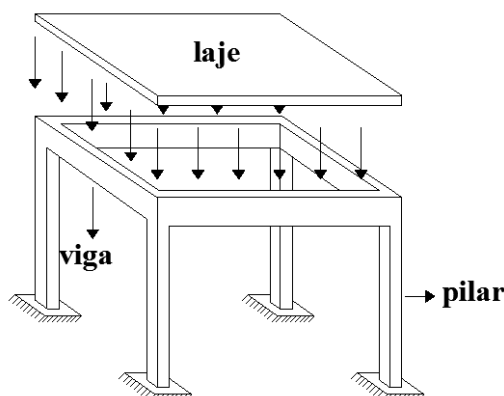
Laje maciça rectângular apoiada em quatro vigas e quatro pilares
